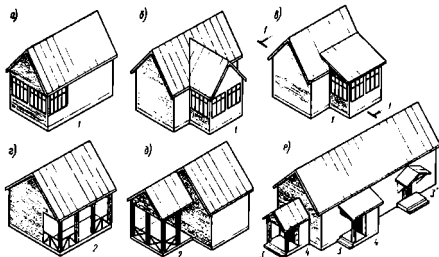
Летние приквартирные помещения малоэтажных жилых зданий:
